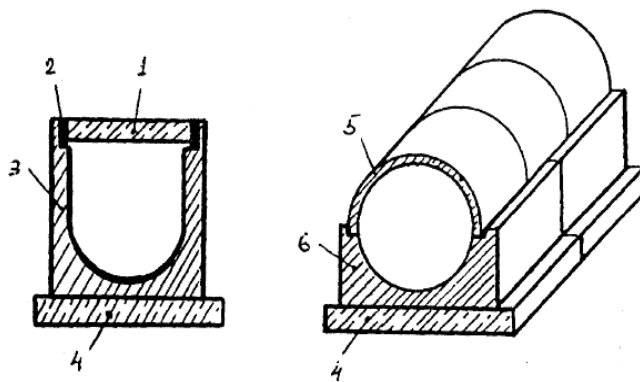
Конструкції колекторів великих діаметрів із збірних залізобетонних елементів напівкруглої та круглої форм.
